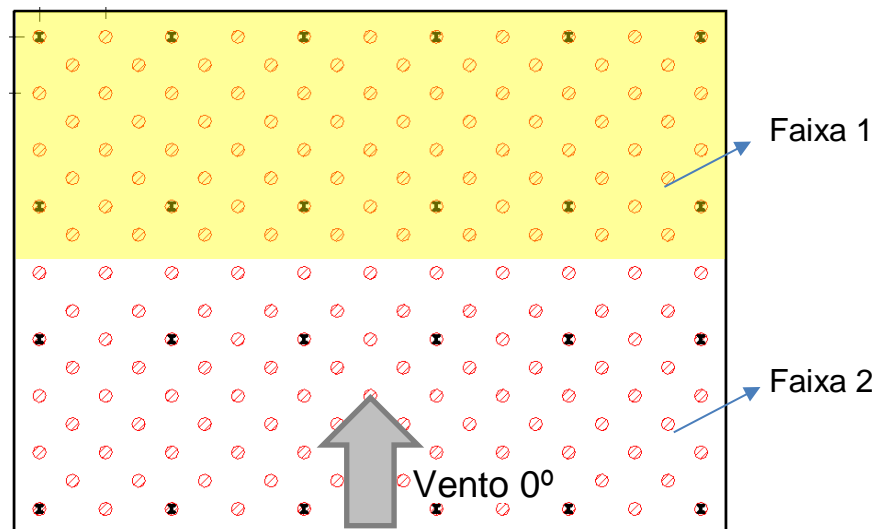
Divisão em 2 faixas a planta de estaqueamento modelo H = 173 m.
